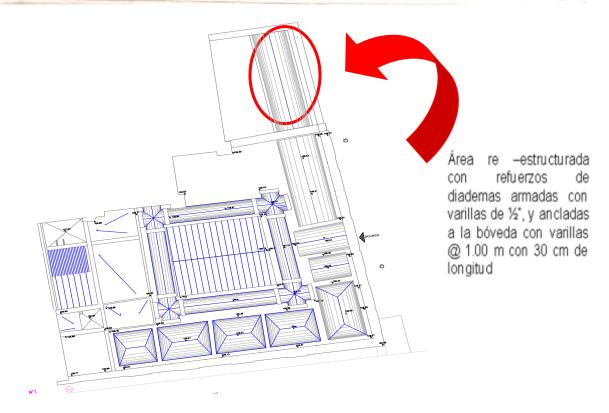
Planta de azotea estado actual. Eloísa Galván González. 2014
